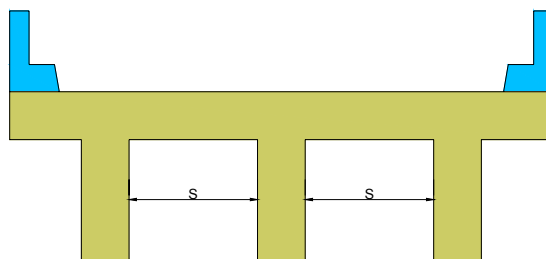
Longitud efectiva para losas monolíticas con vigas
